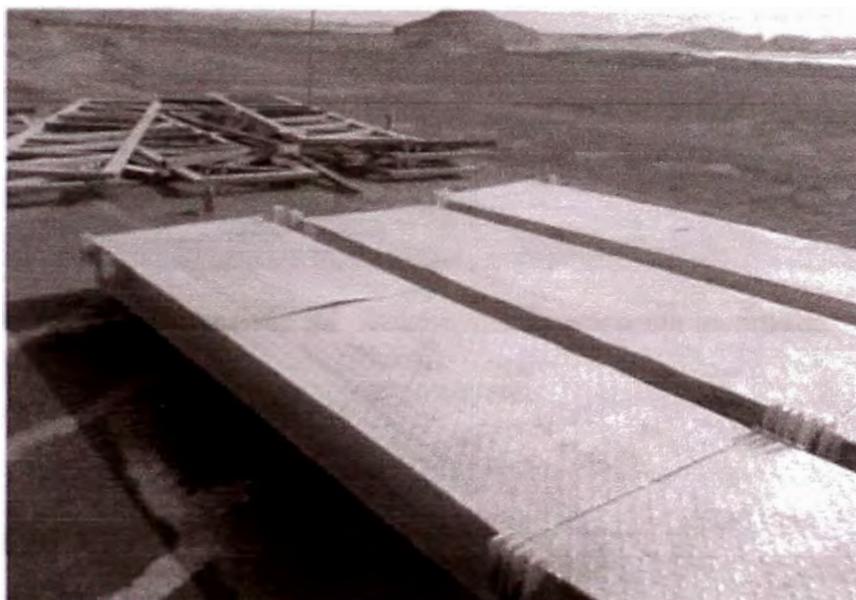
Planchas de pasarelas levantadas y deformadas
